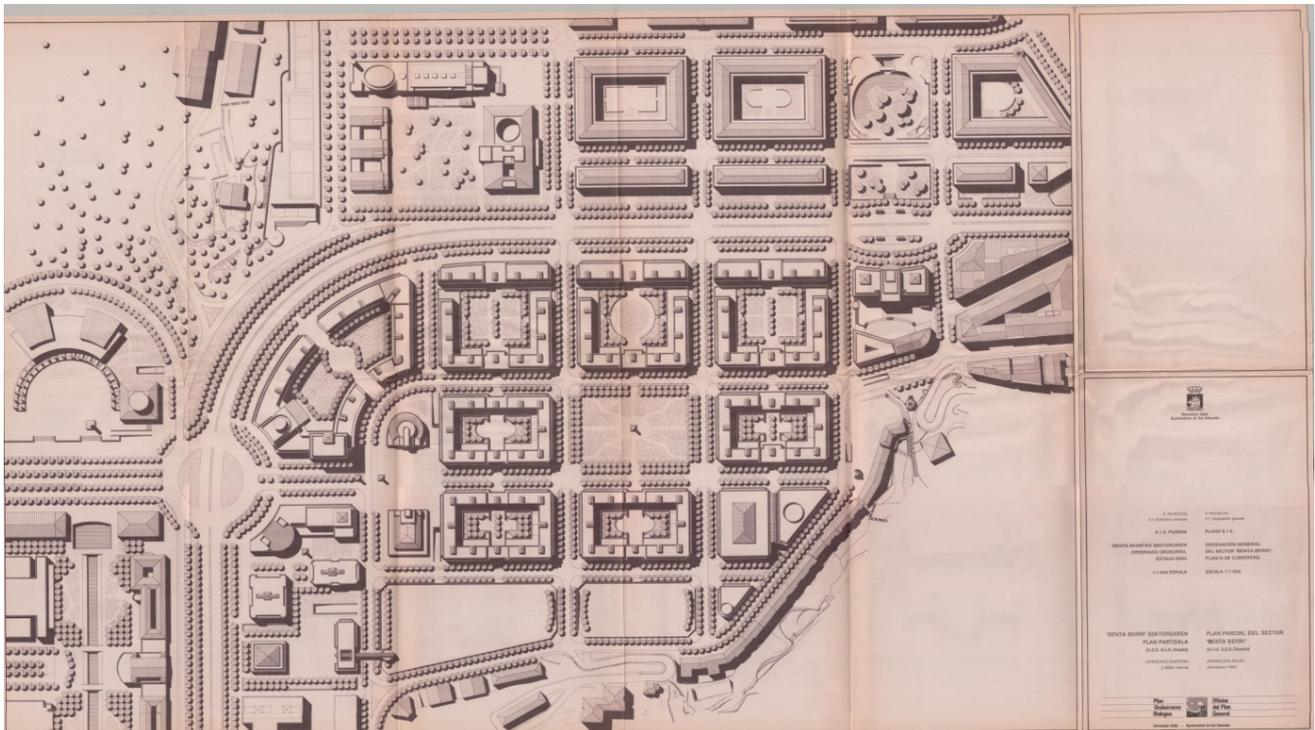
Plano II.1.2. de ordenación general del sector "Benta Berri". Planta de cubiertas - P.P.O.P.G.
